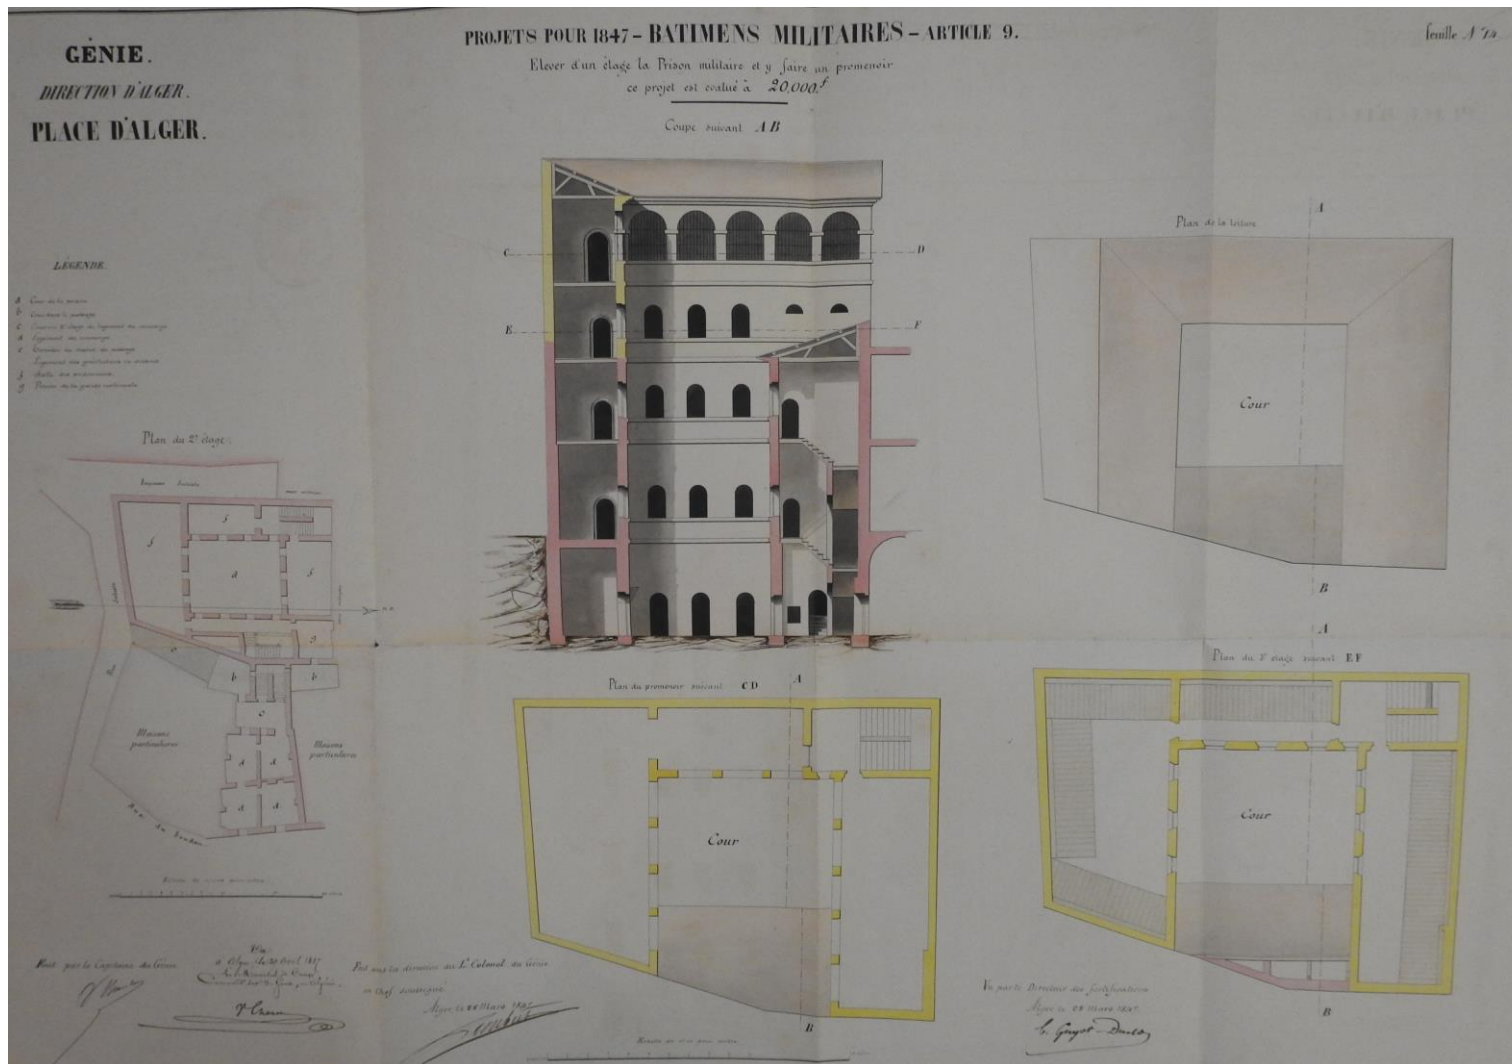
Plan du 2^e étage, les 2 étages d'extension pour les promenades et le plan de toiture plus la coupe (1847).
